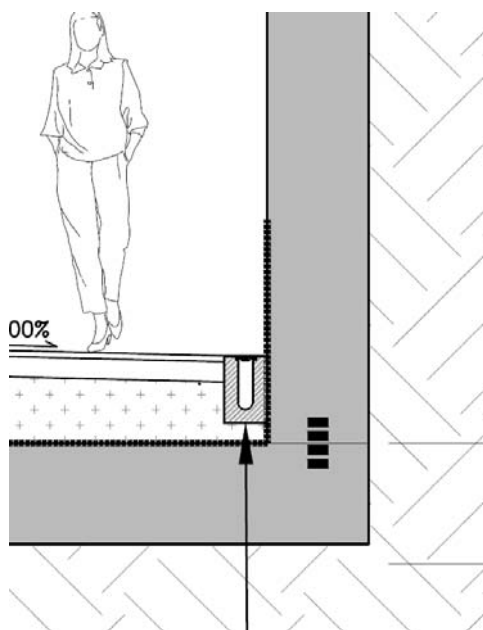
Ingrandimento sezione tipo con inserimento canaletta di raccolta.
